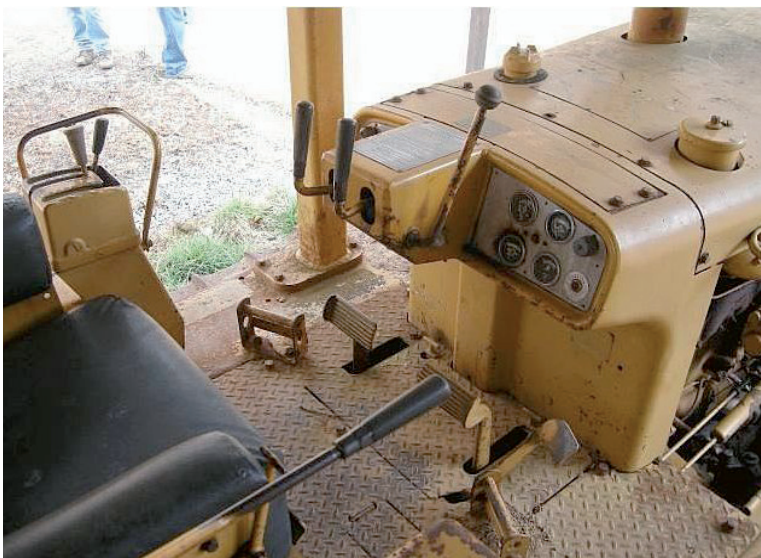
Aspecto de la posición de un CAT D6H sin cabina cerrada. Foto: Autor.
